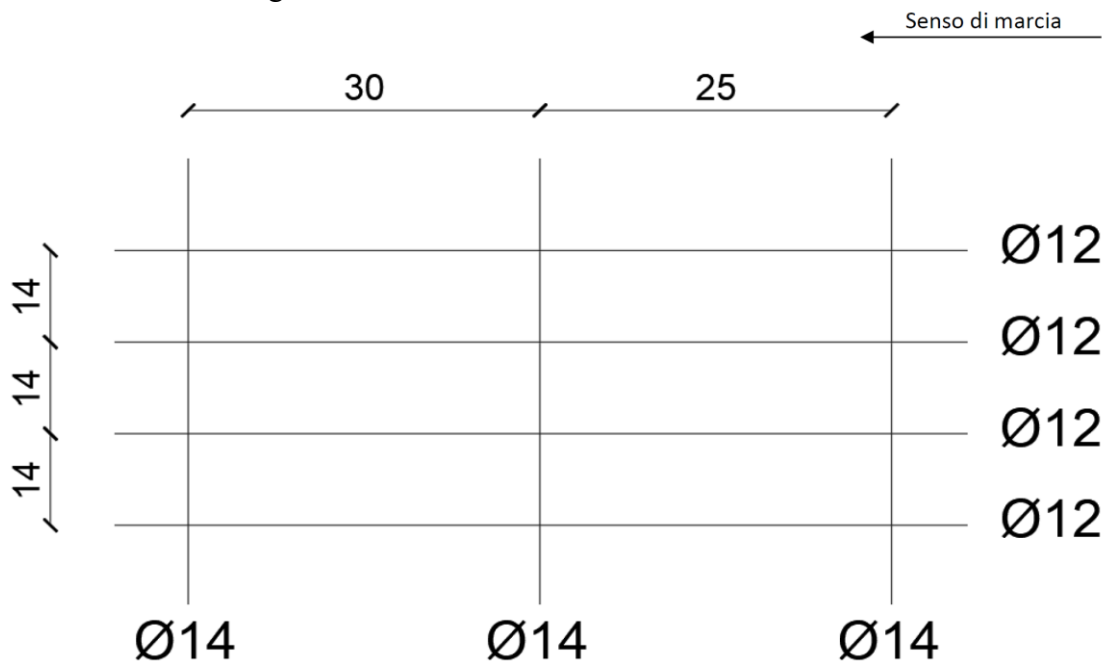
Orditura delle armature superiori della soletta in corrispondenza della sezione di incastro
